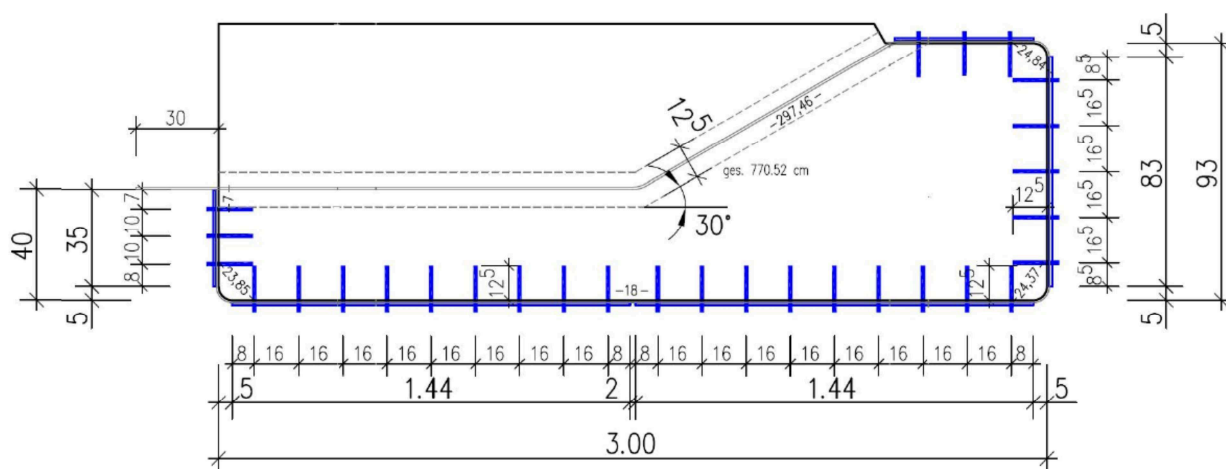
Horizontaler Fugenverlauf im Betonmodell
